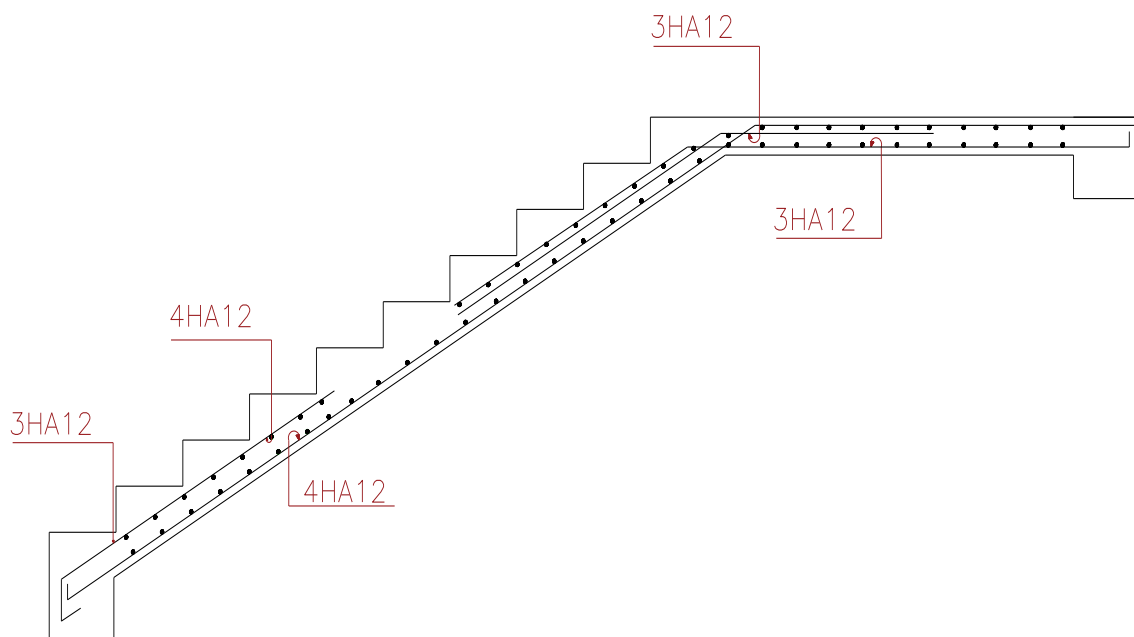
Ferrailage d'escalier sous-sol type 01.
